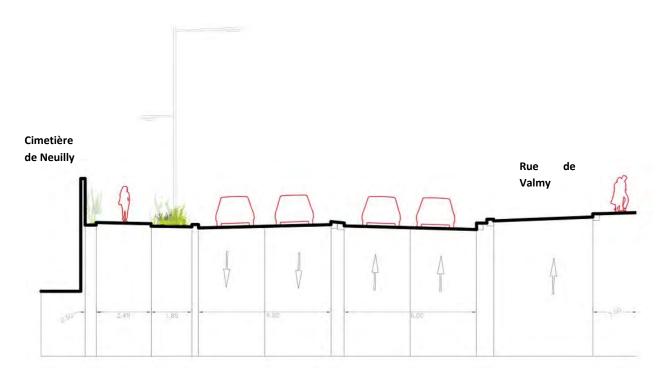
Coupe M-M au droit du cimetière de Neuilly, avant le carrefour de la Folie
